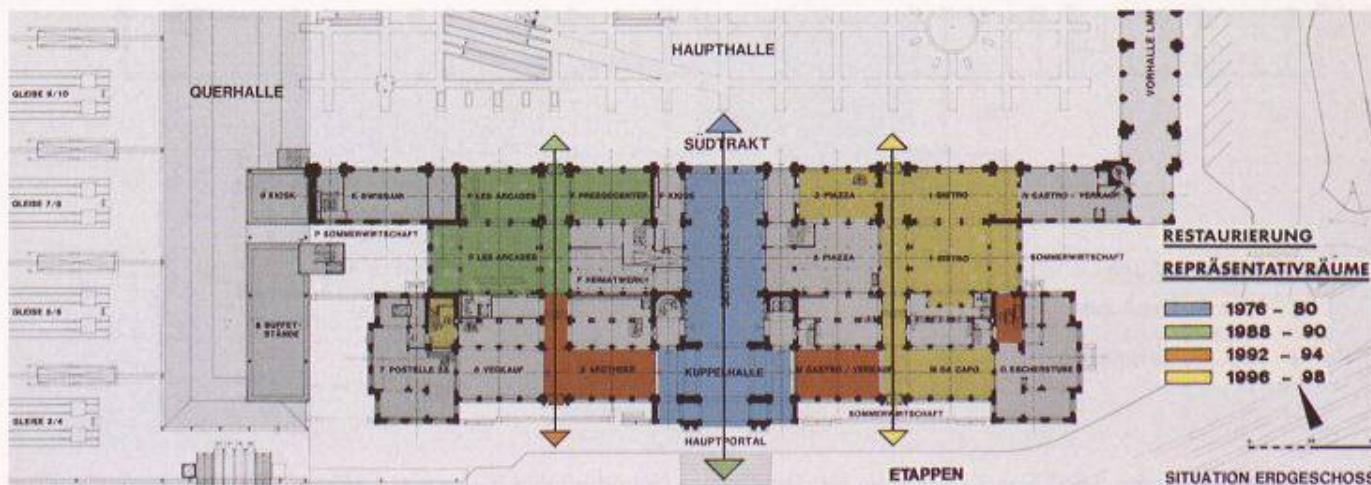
Gesamtplan 1992 (Grundriss Erdgeschoss). Vorgesehene Etappierung der Wiederherstellung
